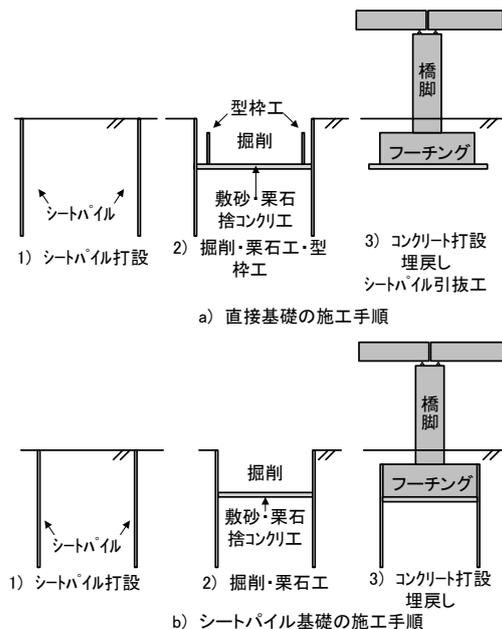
直接基礎とシートパイル基礎の施工手順
